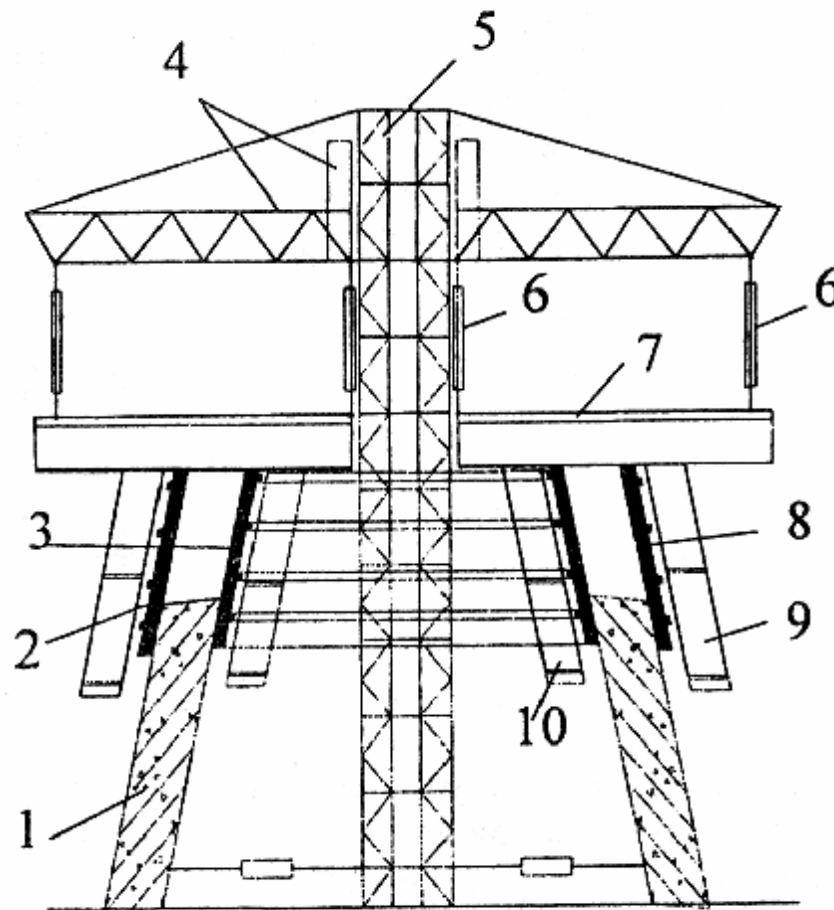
Підйомно-переставна опалубка: 1 – бетонована стіна; 2 – зовнішні опалубні щити; 3 – внутрішні опалубні щити; 4 – піднімальний пристрій; 5 – шахта опорно-піднімального пристрою; 6 – підвіски; 7 – робоча площадка; 8 – опалублення балки; 9,10 – зовнішні і внутрішні підвісні риштування
